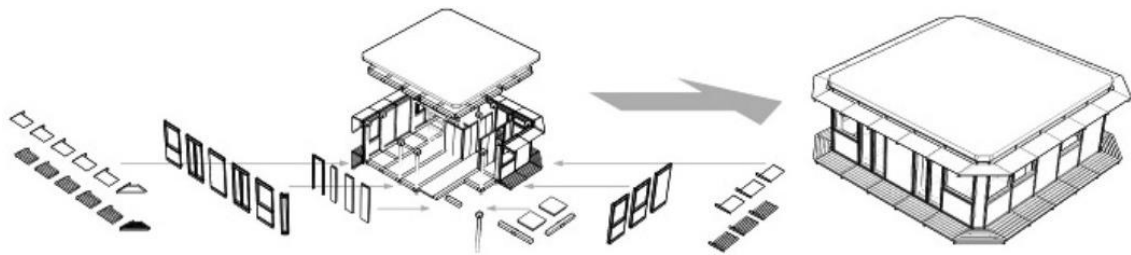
Exemplo do sistema pré-fabricado apresentado pela LUKASLANG
